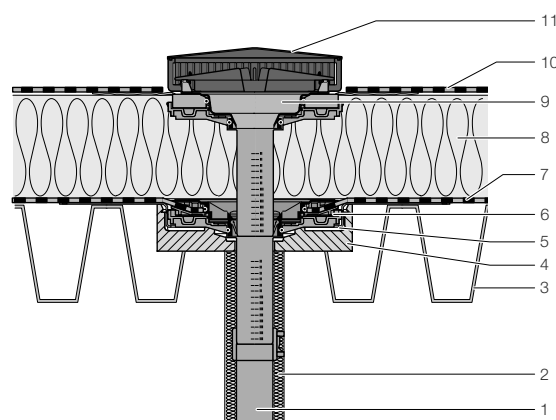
Конструкция легкой кровли, изолированной, с креплением пароизоляции
